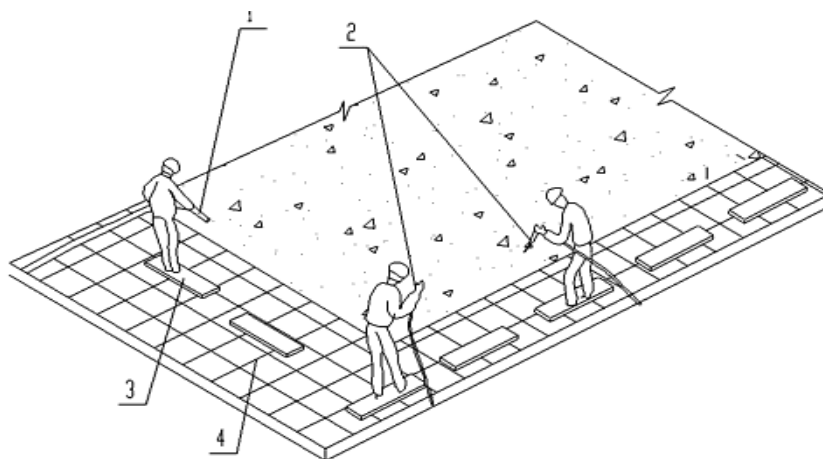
Схема рабочего места при бетонировании плиты:
